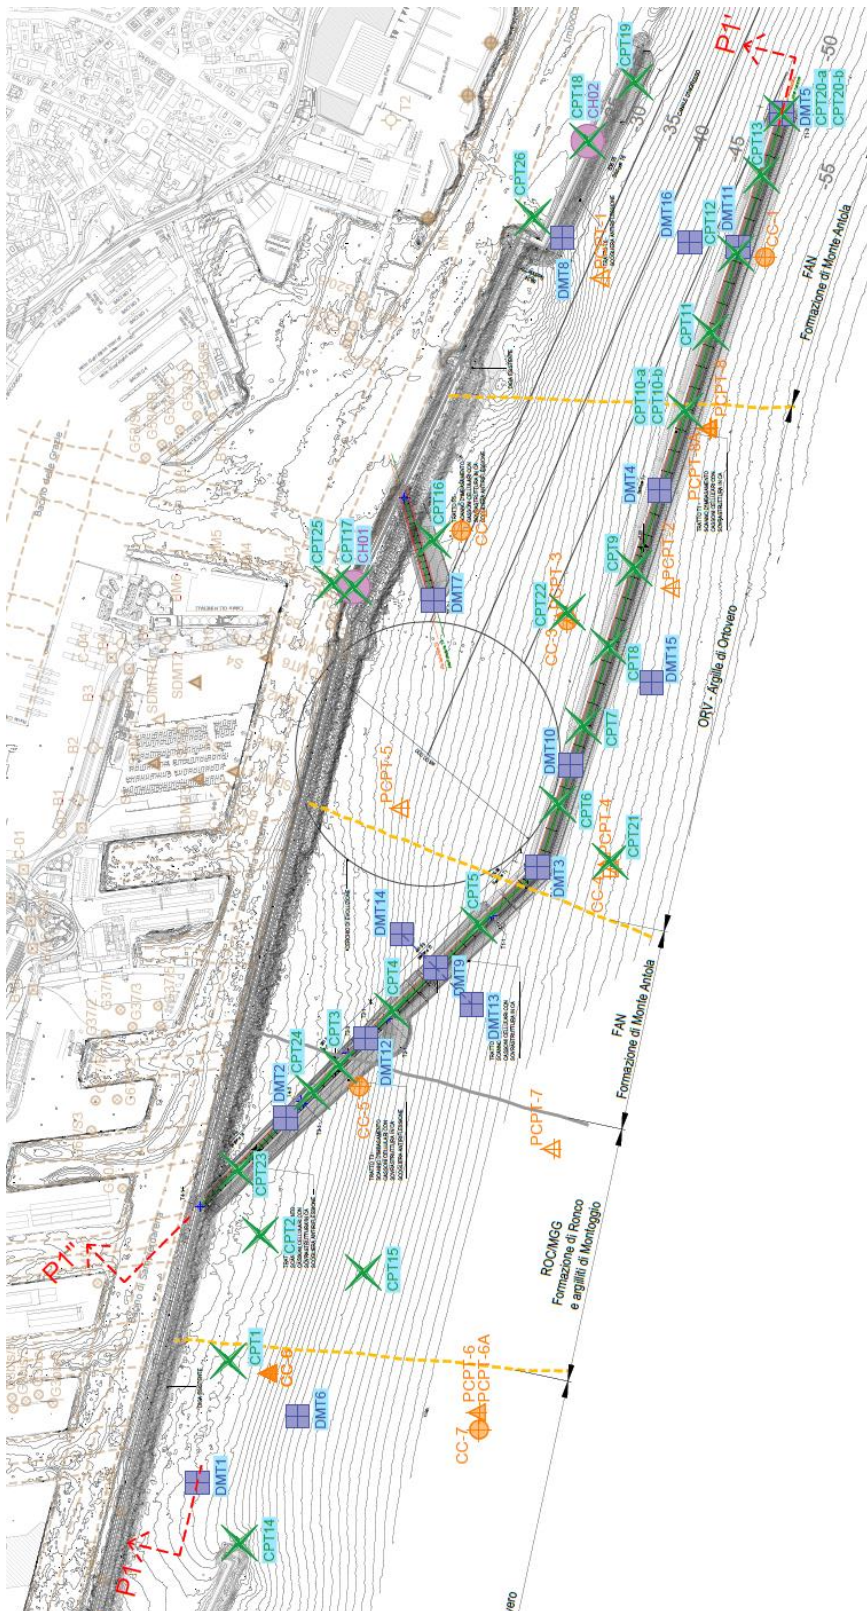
Planimetria ubicazione indagini di PFTE e di PE
